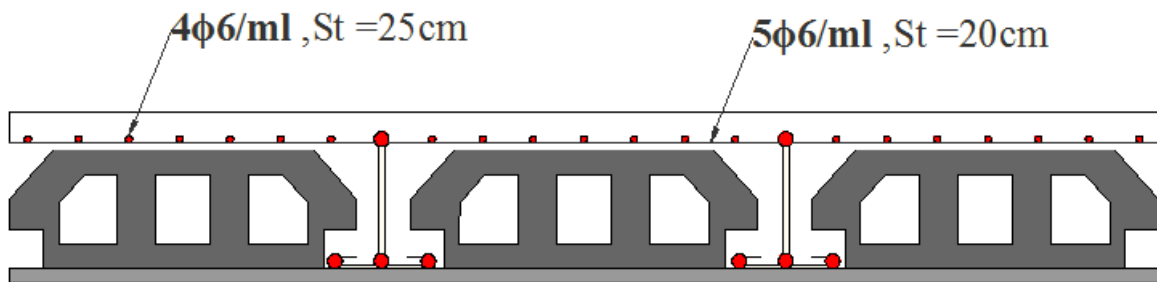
Schéma de ferrailage de la dalle de compression.
